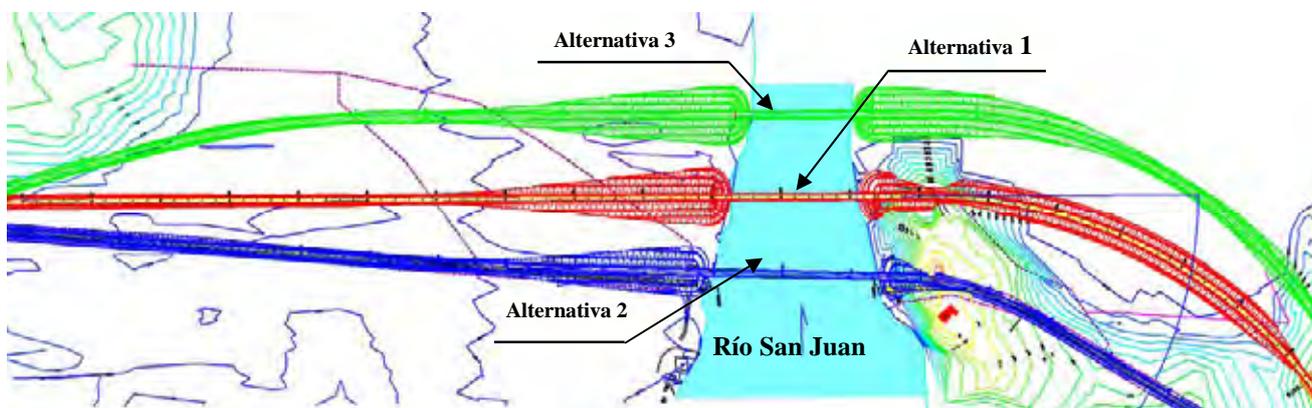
Primera selección de alternativas de ubicación para la construcción del puente
